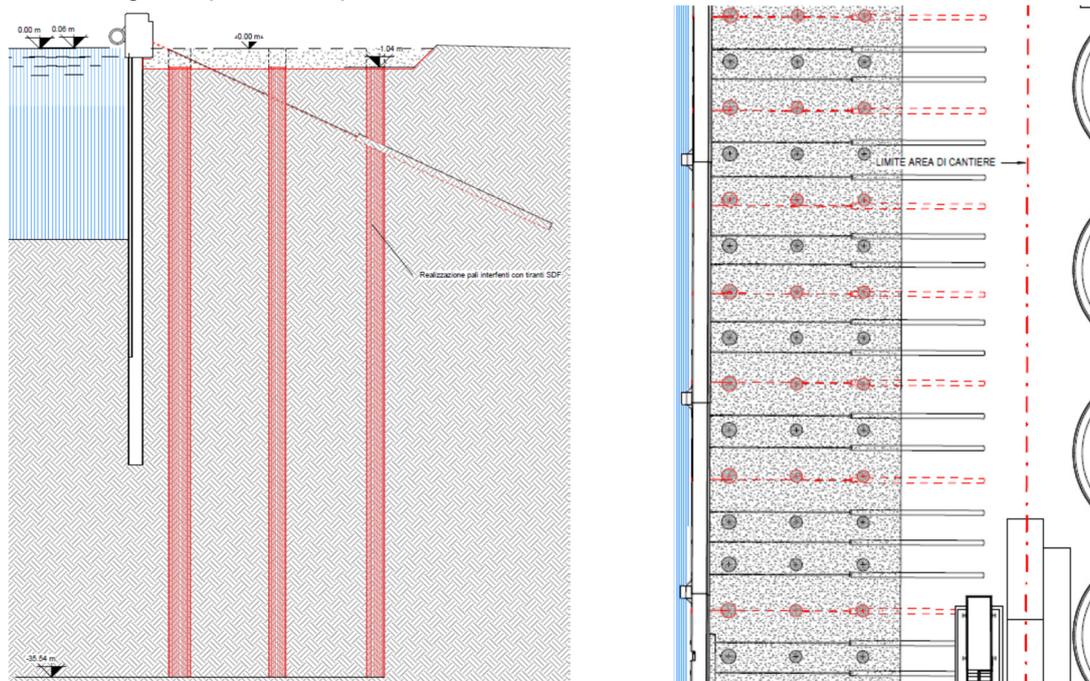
Banchina Bunge Sud – Fase 4 – Sezione e planimetria
